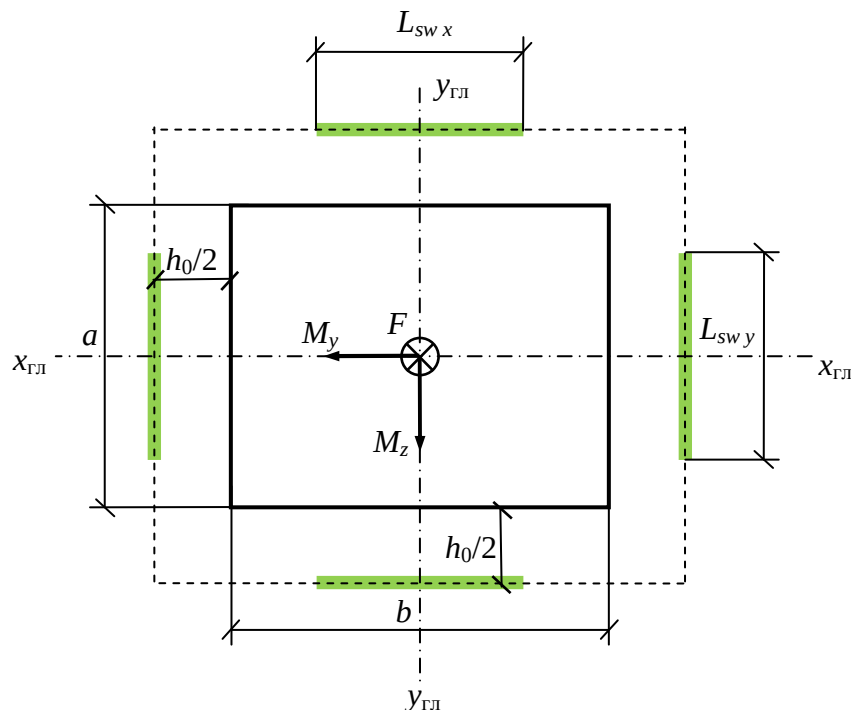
Сечение колонны и расчетный контур продавливания внутри плана плиты перекрытия.
